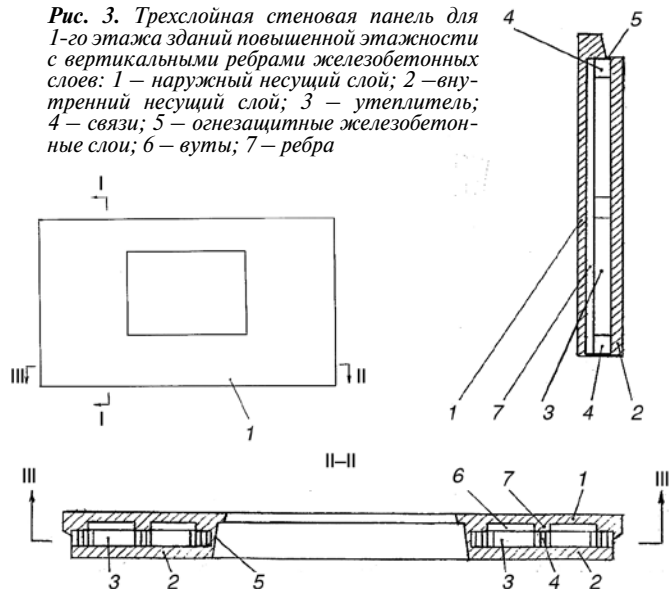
Трехслойная стеновая панель для 1-го этажа зданий повышенной этажности с вертикальными ребрами железобетонных слоев: 1 – наружный несущий слой; 2 – внутренний несущий слой; 3 – утеплитель; 4 – связи; 5 – огнезащитные железобетонные слои; 6 – вуты; 7 – ребра
